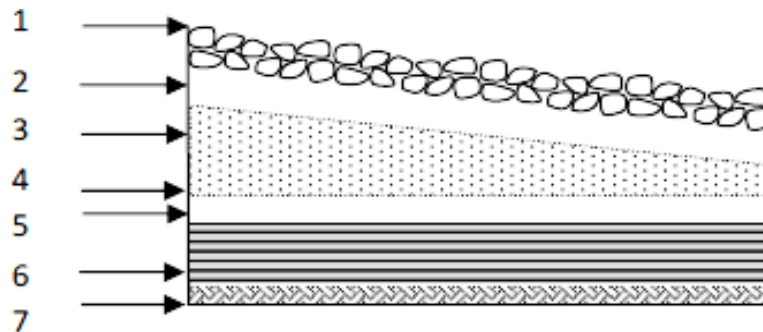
Coupe verticale d'un plancher d'étage terrasse inaccessible
